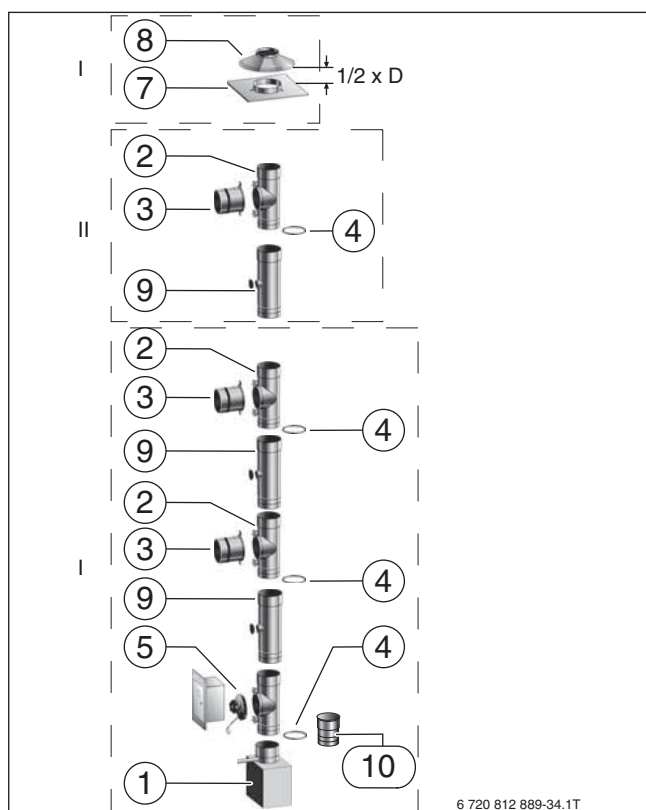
Bauteile des Bausatzes Mehrfachbelegung
